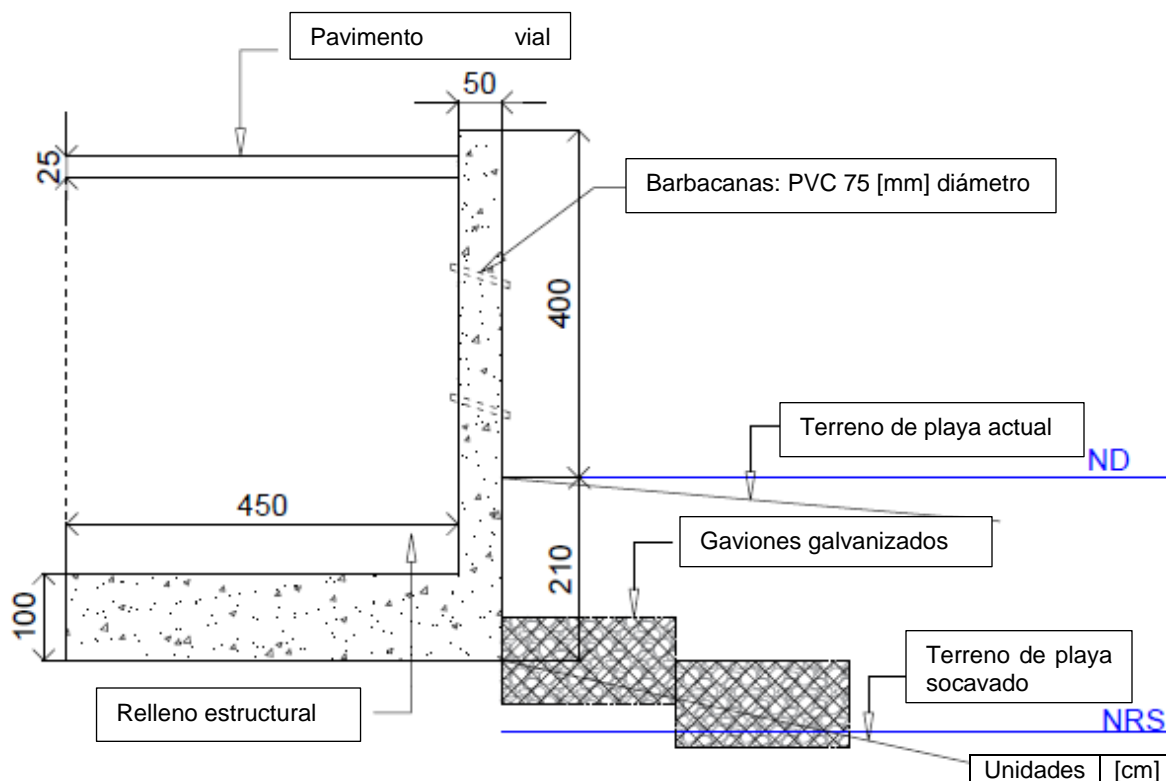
PLANO EN PERFIL DE SECCIÓN DE MURO CANTILÉVER. FUENTE: ELABORACIÓN PROPIA.
